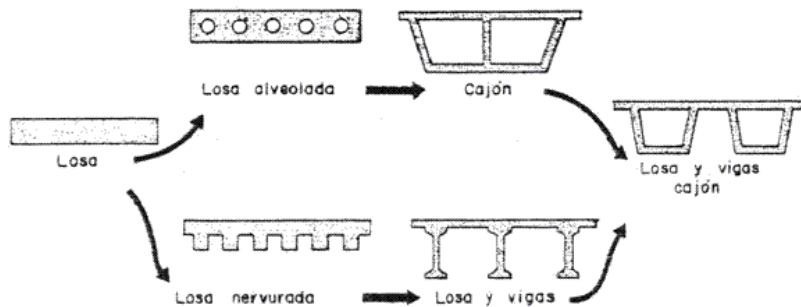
Tipos de elementos horizontales empleados para la construcción de puentes en viga. (*ingenierocivilinfo.com, 2015*)
